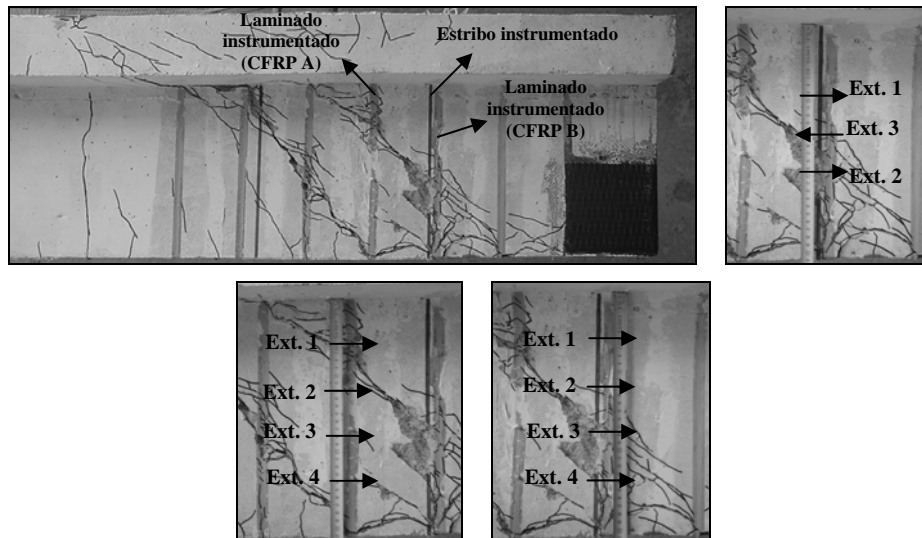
Localização dos extensómetros no laminado e estribo instrumentados da viga 2S-7LV-B.
